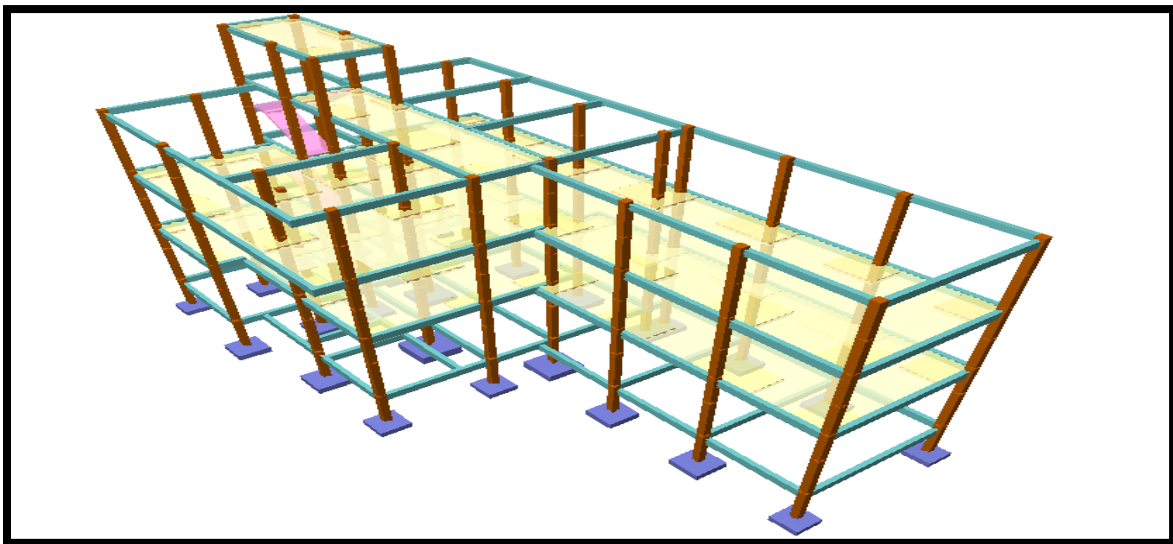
Esquema de la edificación con losa plana reticular, Elaboracion propia
